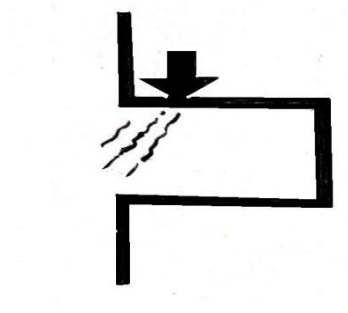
Detalle de fisuras producidas por un esfuerzo cortante.
